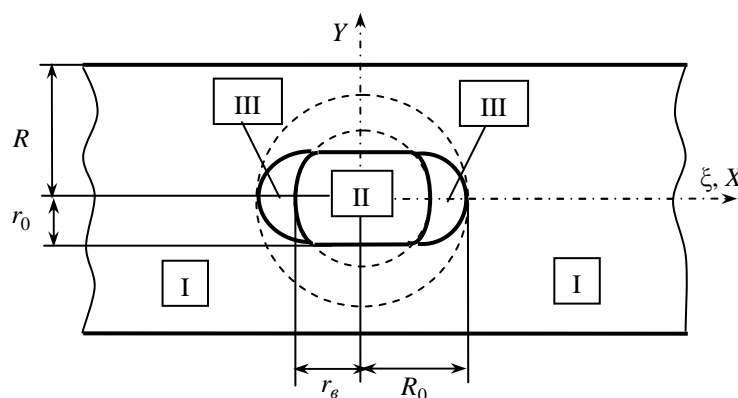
Форма и основные размеры в плане вмятины на поверхности цилиндрической оболочки
